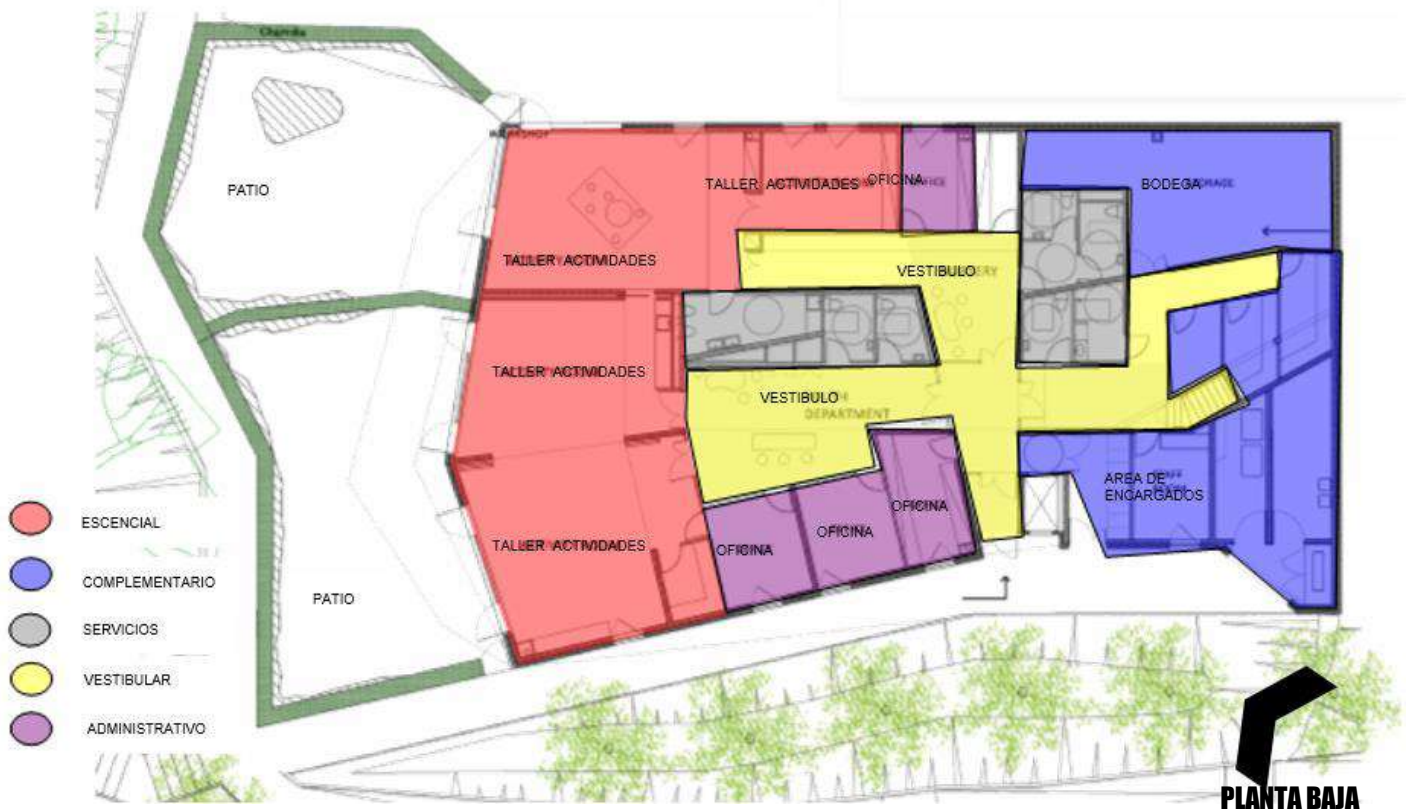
Planta baja arquitectónica del Centro Comunitario en Billère
